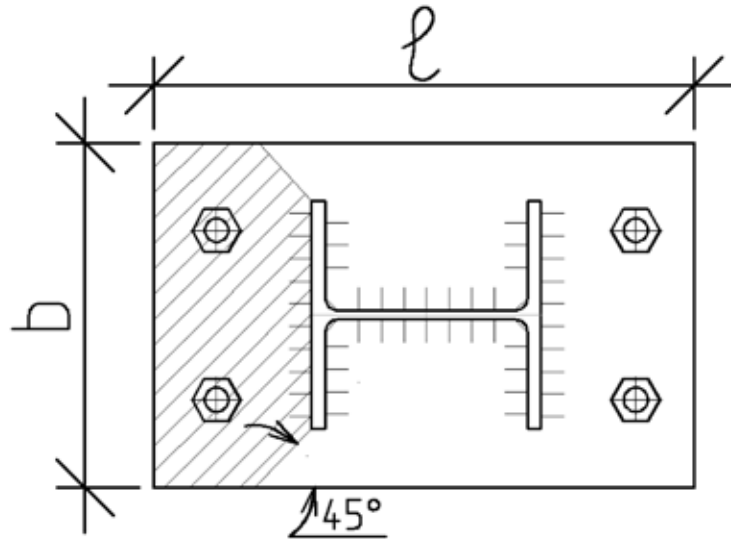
Схема грузовой площади при расчёте плиты базы на изгиб от отпора фундамента на плиту
